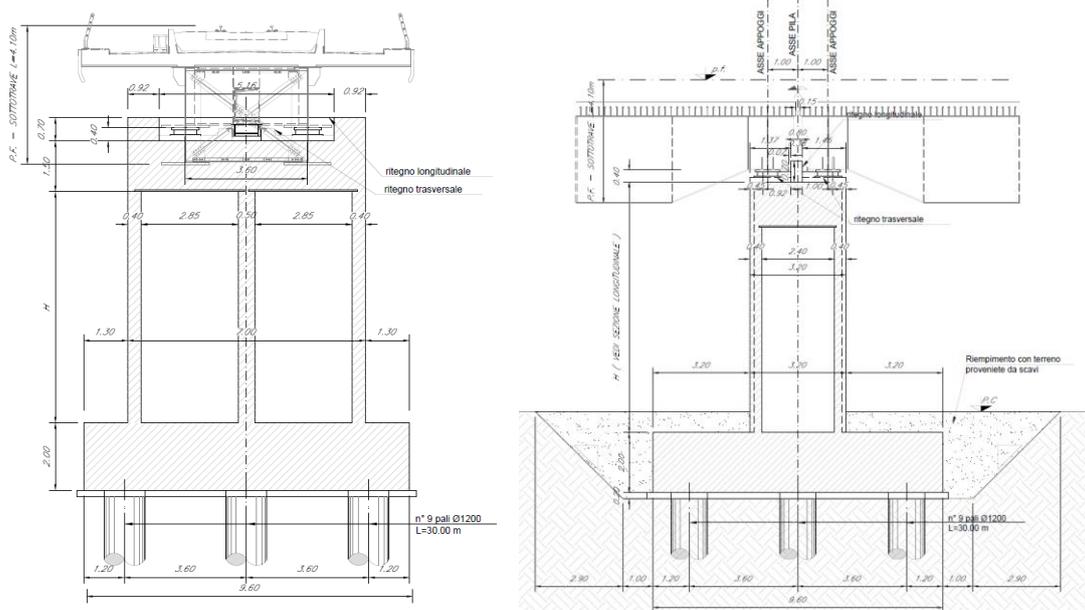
Sezione in direzione trasversale e longitudinale rispetto all'asse del viadotto
